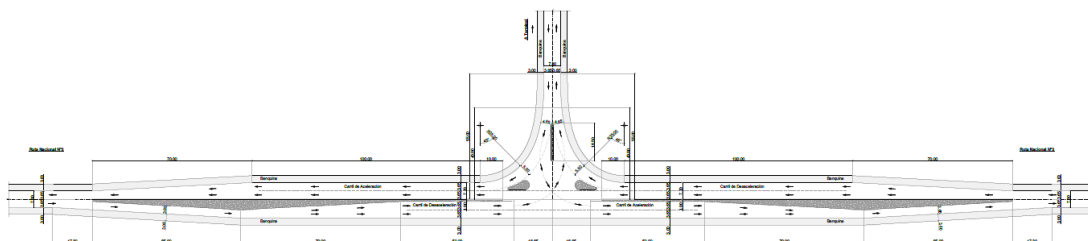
Planimetría de intersección del acceso con la Ruta Nacional 3.
